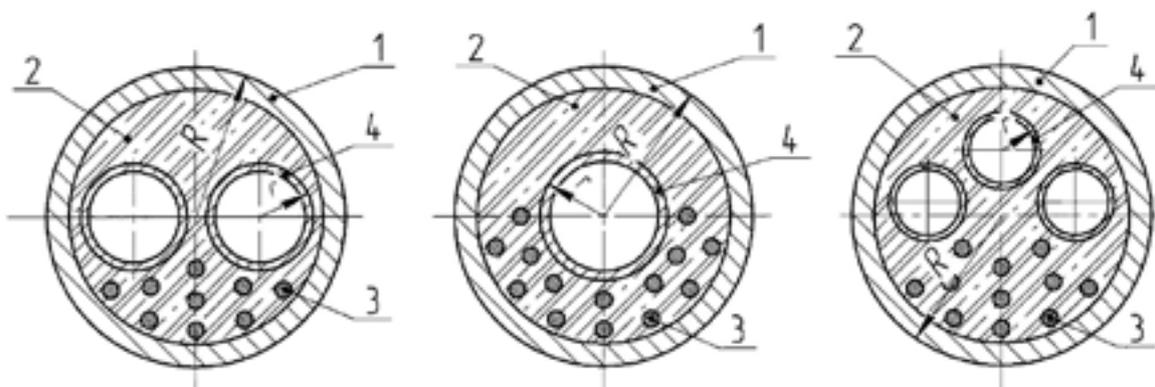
Сечения модифицированных предварительно напряженных трубобетонных балок. 1 – труба, 2 – бетонное ядро, 3 – армирующие элементы, 4 – внутренние продольные трубы
